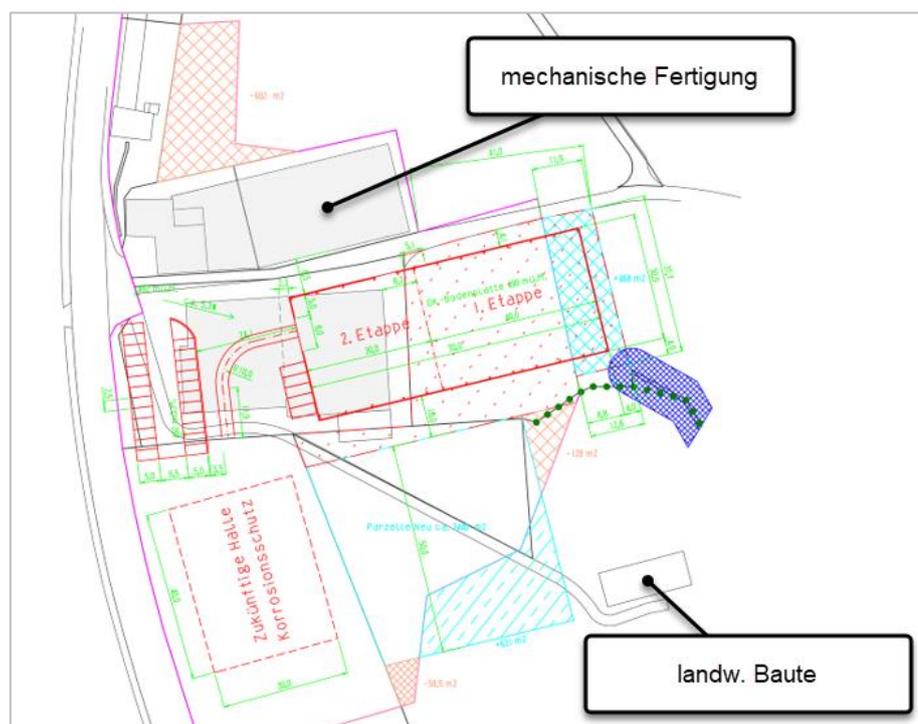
Bebauungskonzept Ersatzneubau Vormontage und Schlosserei (etappiert, geplant) sowie Halle für Korrosionsschutz-Behandlung (spätere Realisierung)
